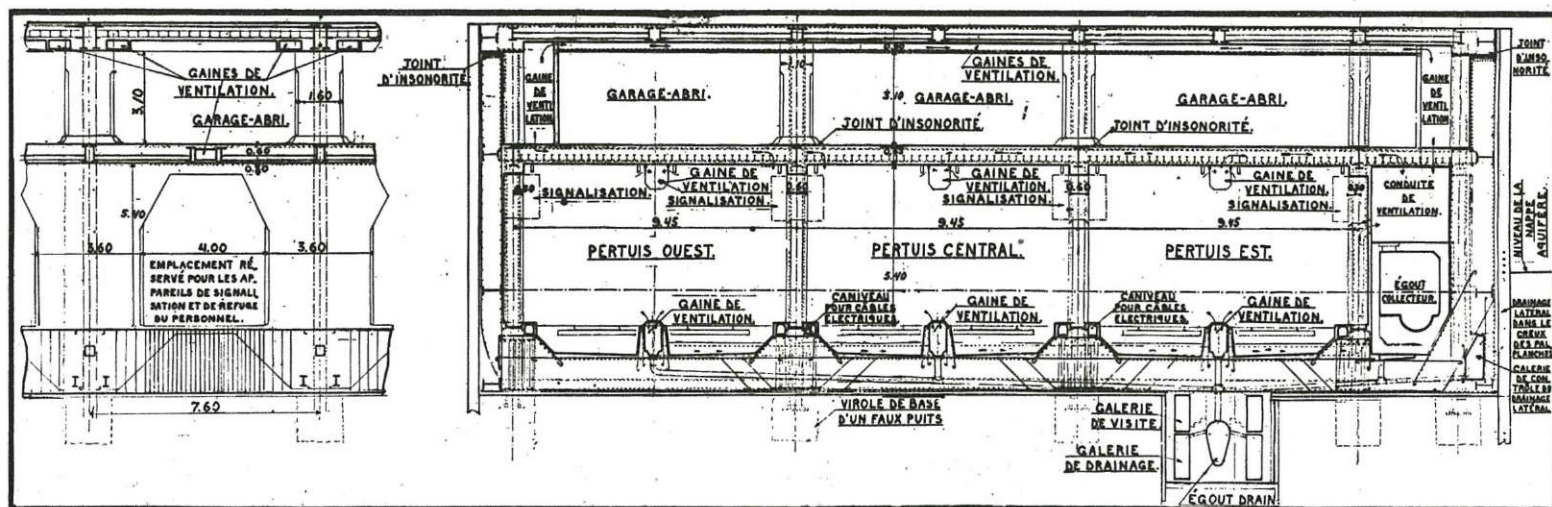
Coupe du tunnel de la Jonction. A gauche, coupe longitudinale ; à droite, coupe transversale.
